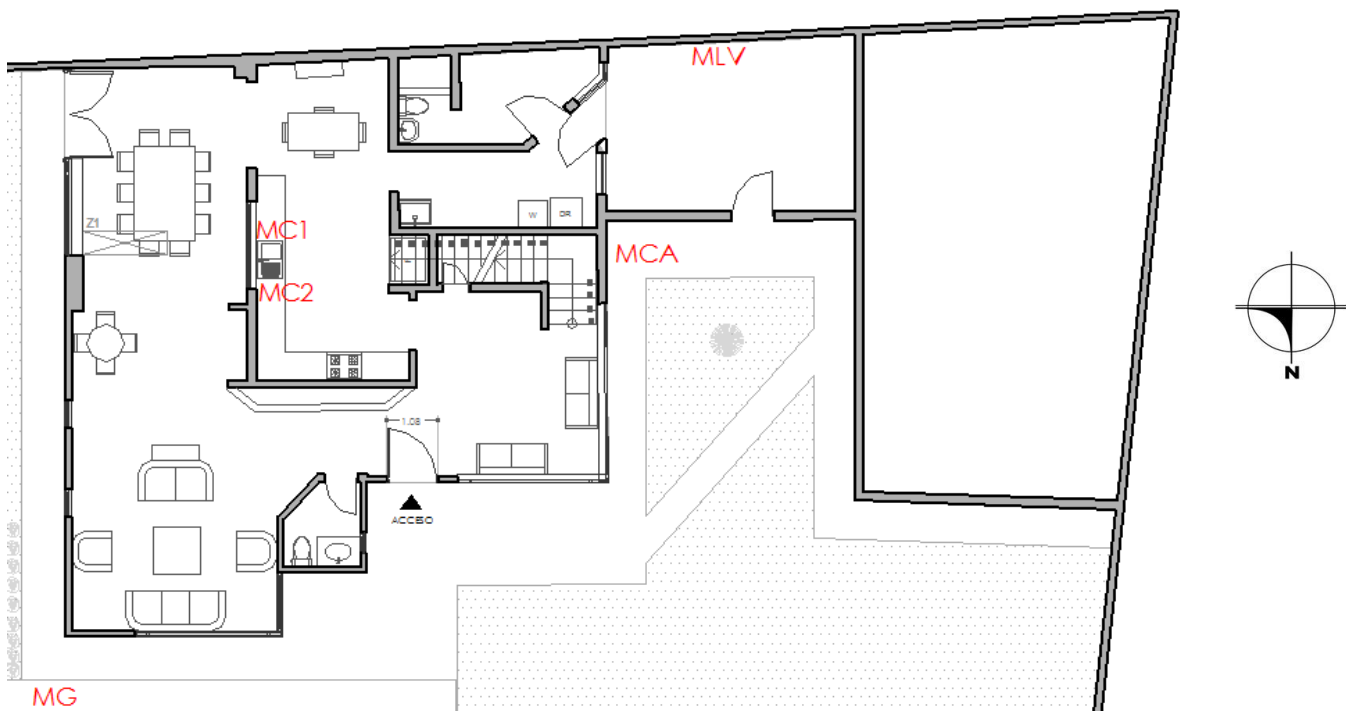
Primera Planta, lugares en donde se instaló medidores
